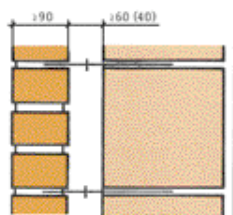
Двухслойная облицовочная кладка с воздушной прослойкой
